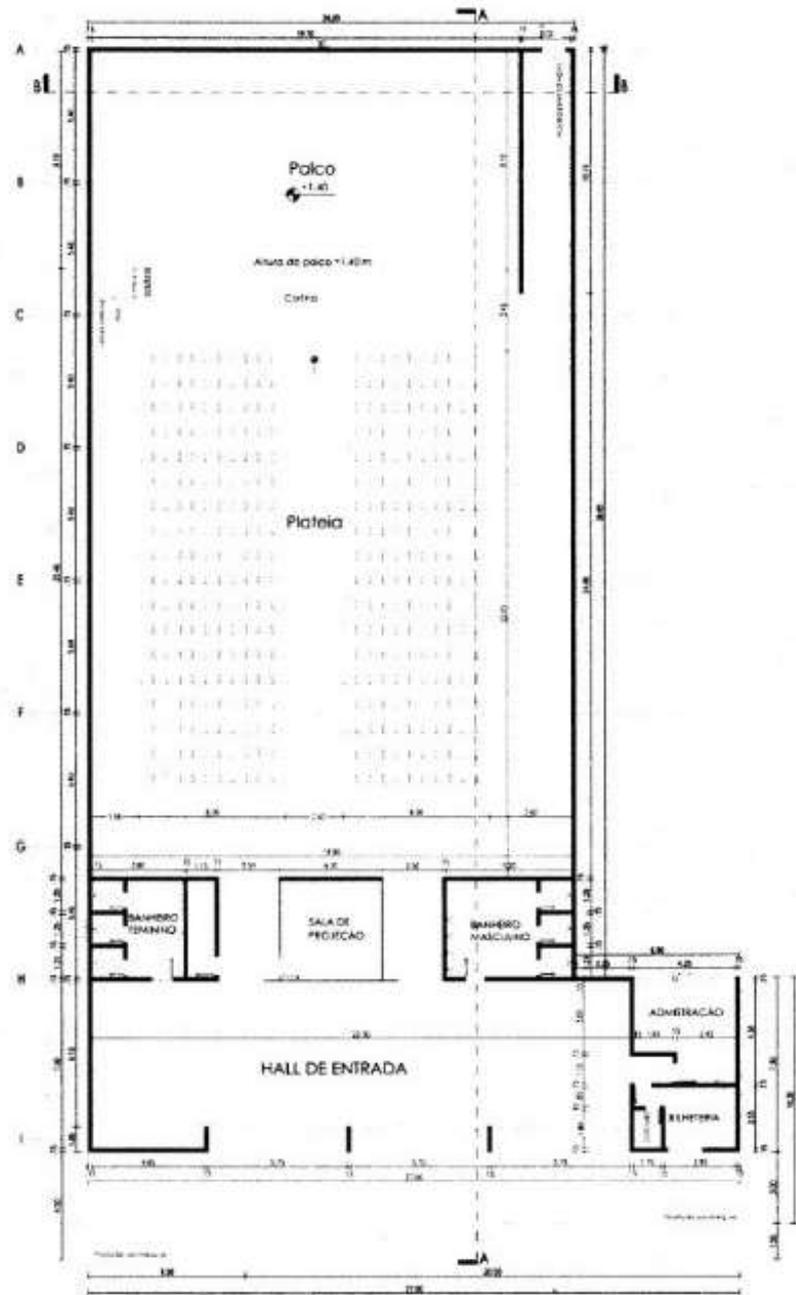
Planta Térrea - levantamento do Prédio Original - do arquiteto Rock Lane
